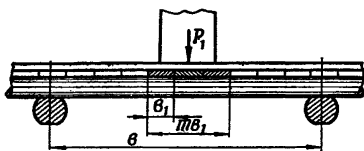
Расчетная схема поперечин при расположении колеса или гусеницы посередине расстояния между прогонами
